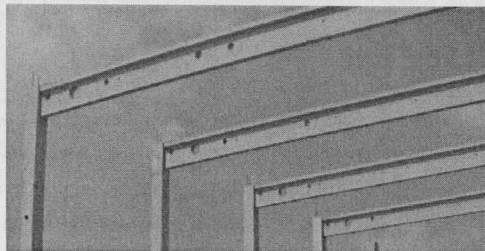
Ausführungsbalken mit großer auflagernahe Aussparung
